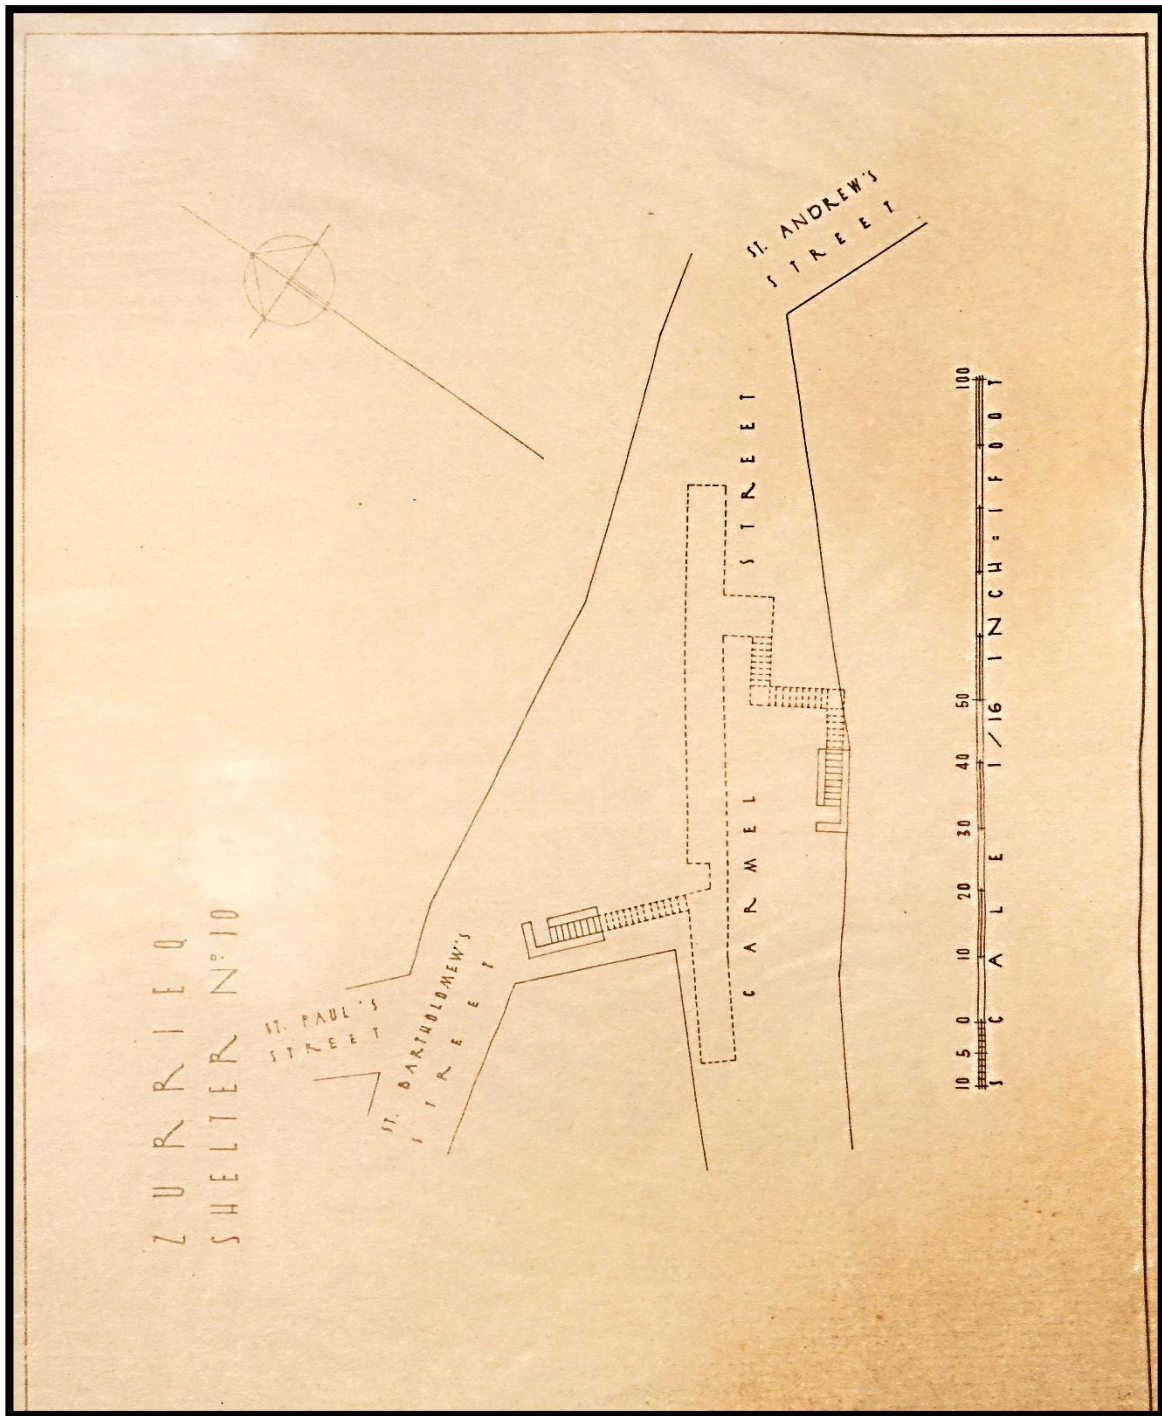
Planta do Abrigo nº10 "St. Bartholomew's Street – St. Paul's Street – Carmel Street – St. Andrew's Street."
